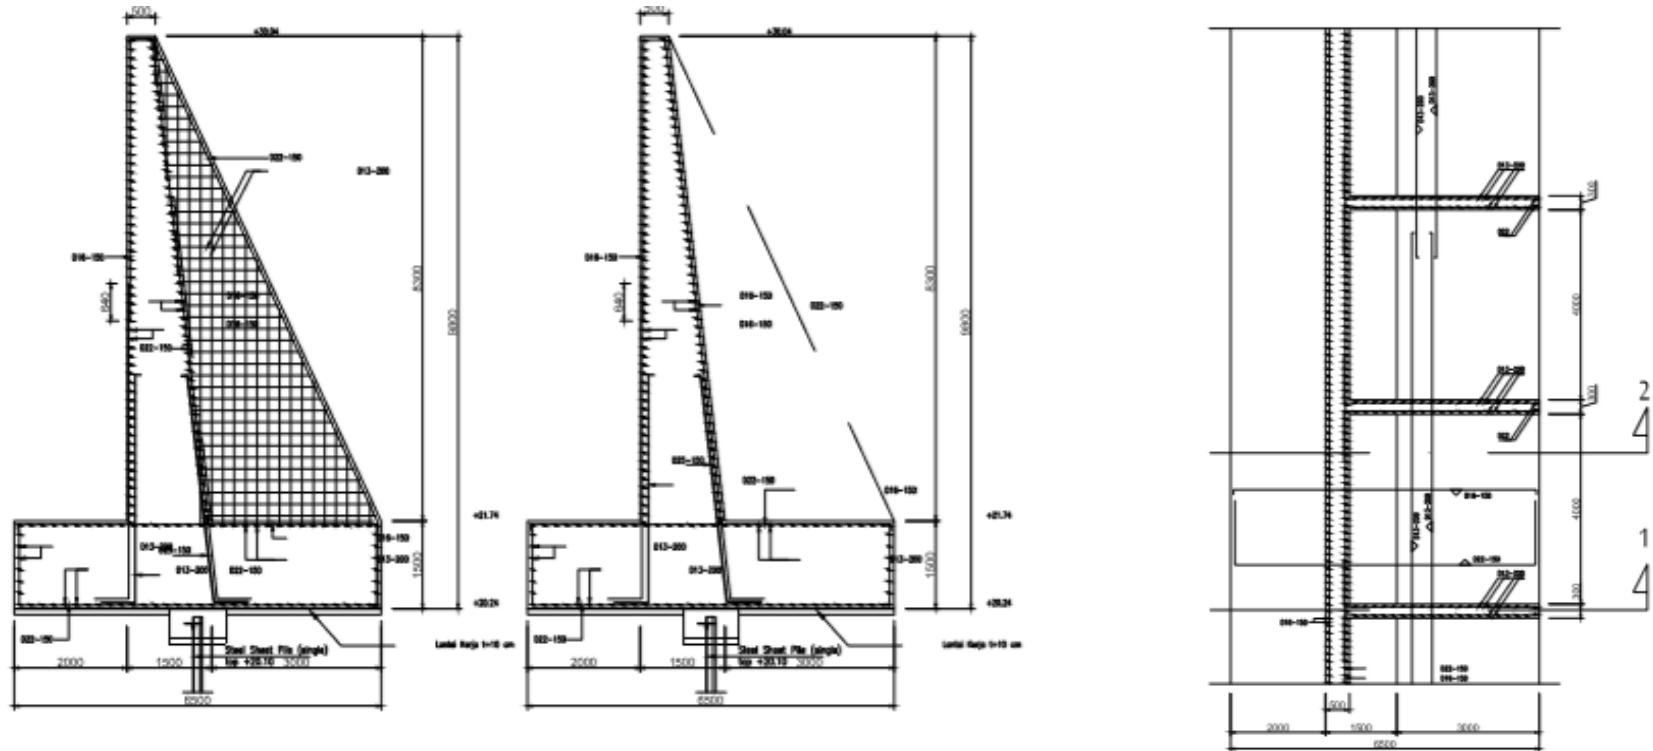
Detail Penulangan dan Denah Tampak Atas Dinding Penahan Tanah Tipe C
